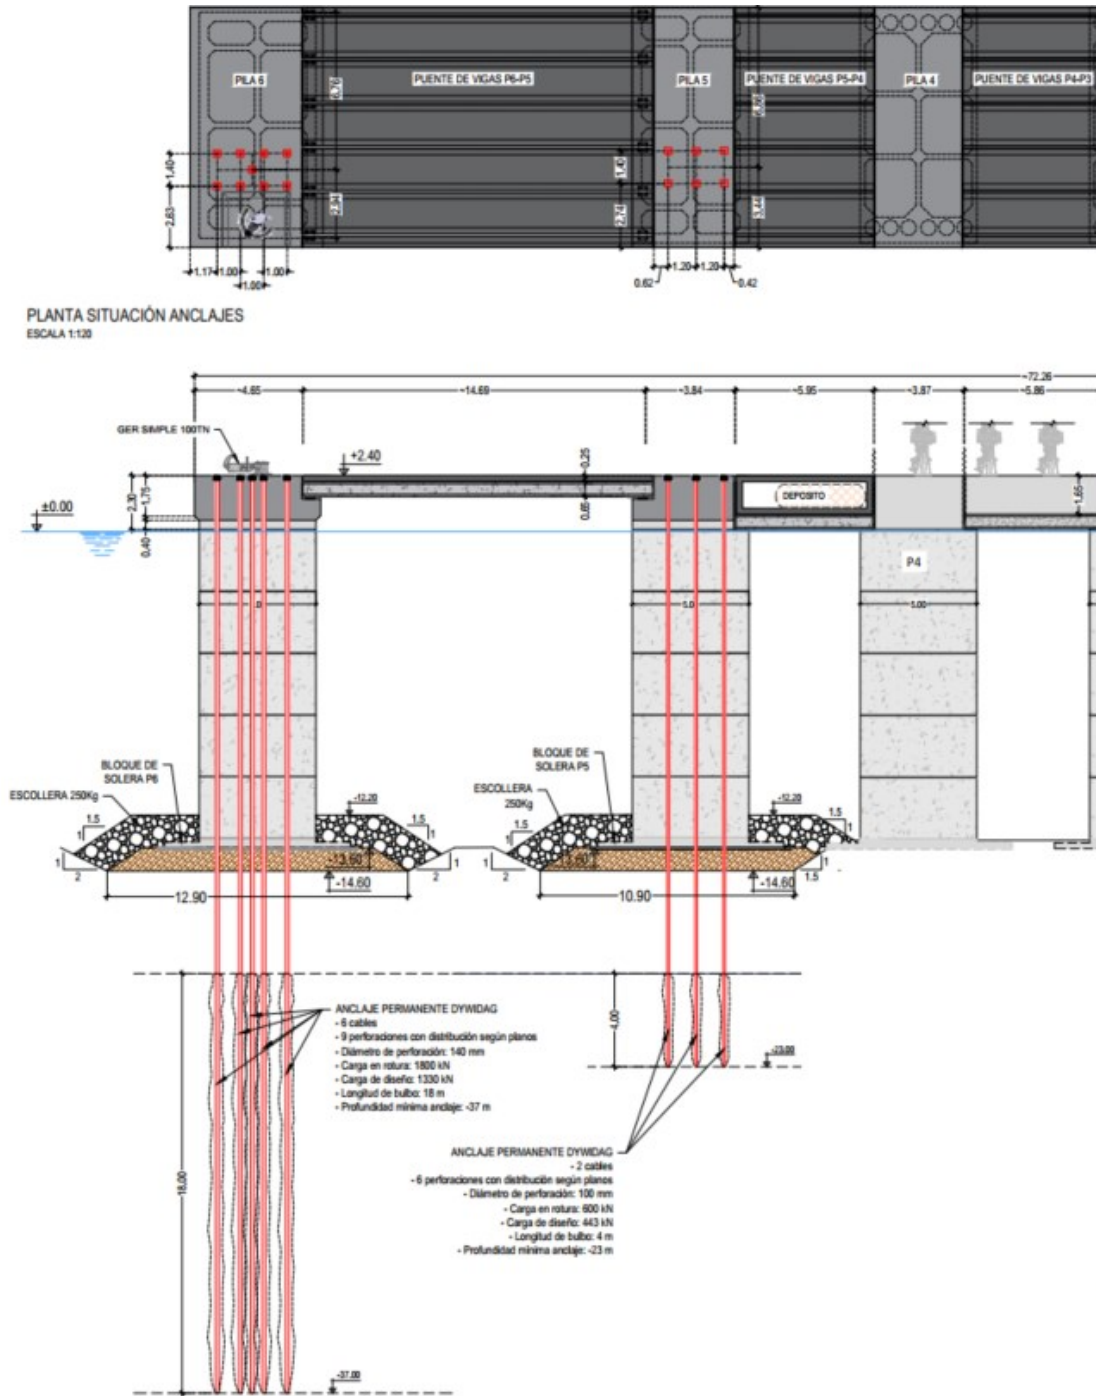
Anclaje en pilas P5 y P6. Planta y Alzado.
